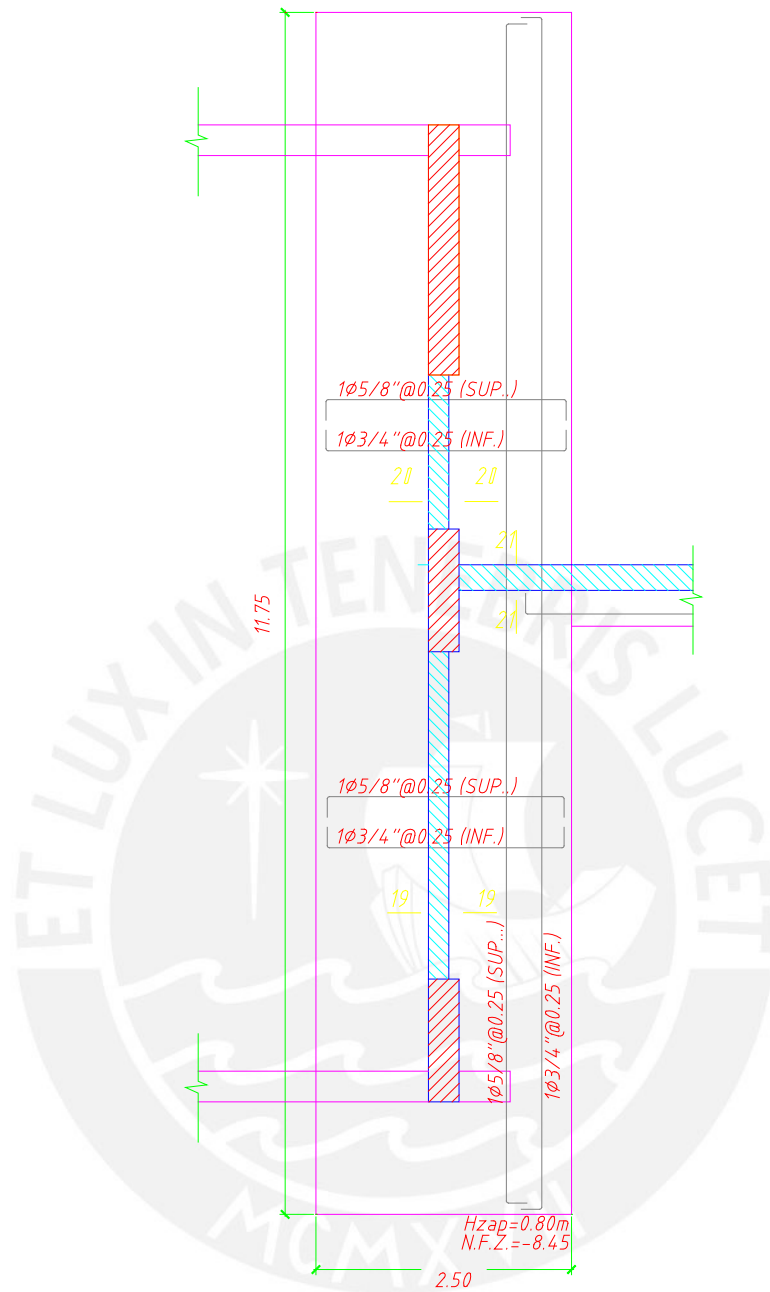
Zapata combinada de la zapata en planta de cimentación
